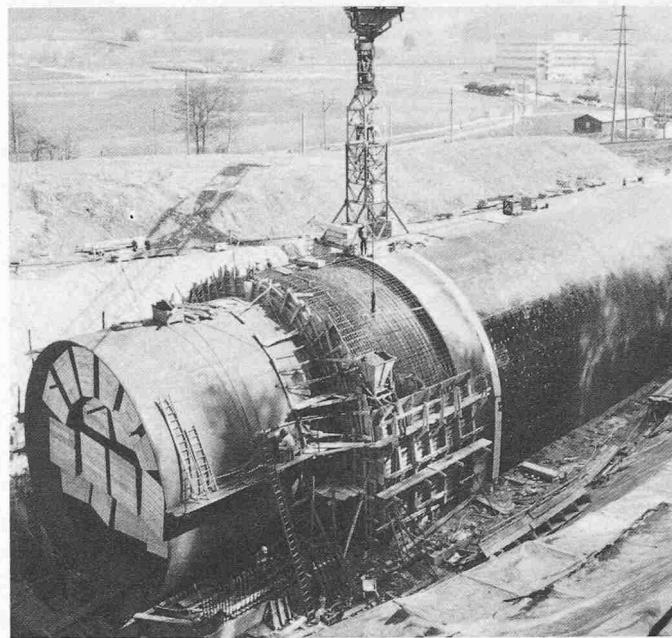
Los Ost. Im Tagbau erstelltes Tunnelstück mit fertig montiertem Vortriebschild und ausgefahrenem Brustverbau
